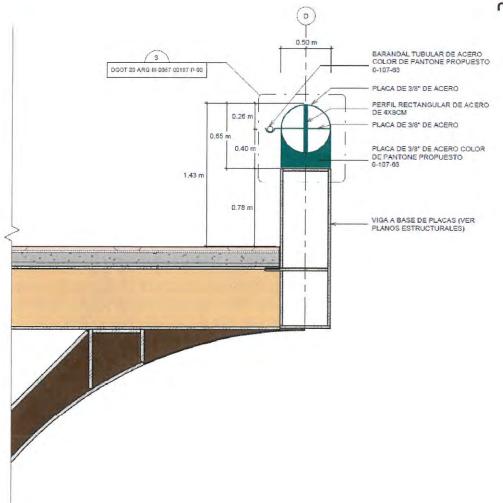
Vista en corte de diseño de barandal apoyado sobre cajón lateral (viga longitudinal) de la pasarela.
